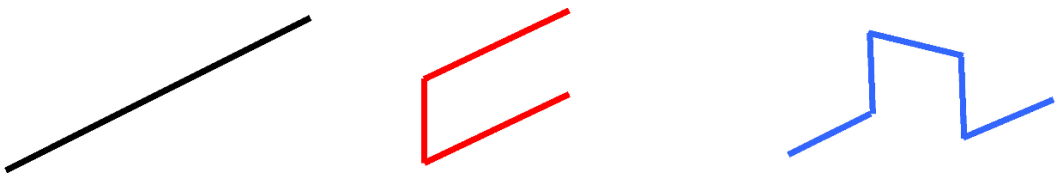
Die Betrachtung der linearen, ebenen und räumlichen Stabstahlbiegeformen in perspektivischer Darstellung.
